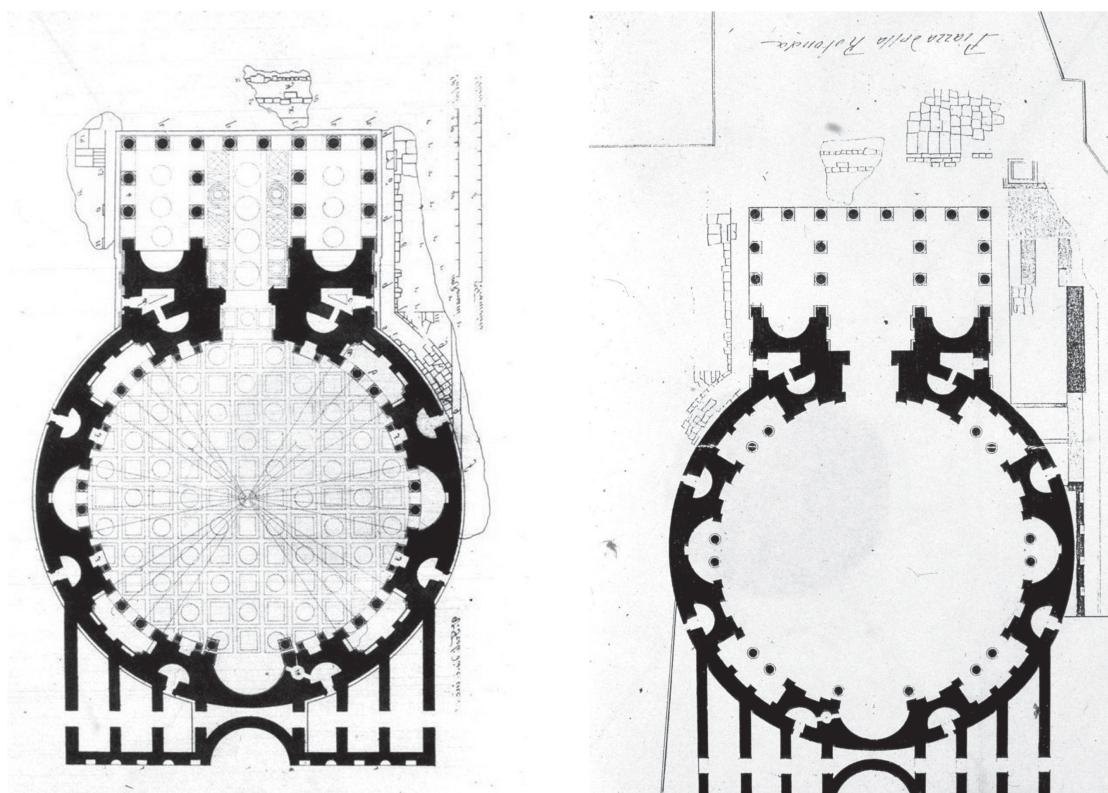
Fea 1804. Planimetria dell'area dello scavo (Sovraintendenza B.C. Archivio Storico).
